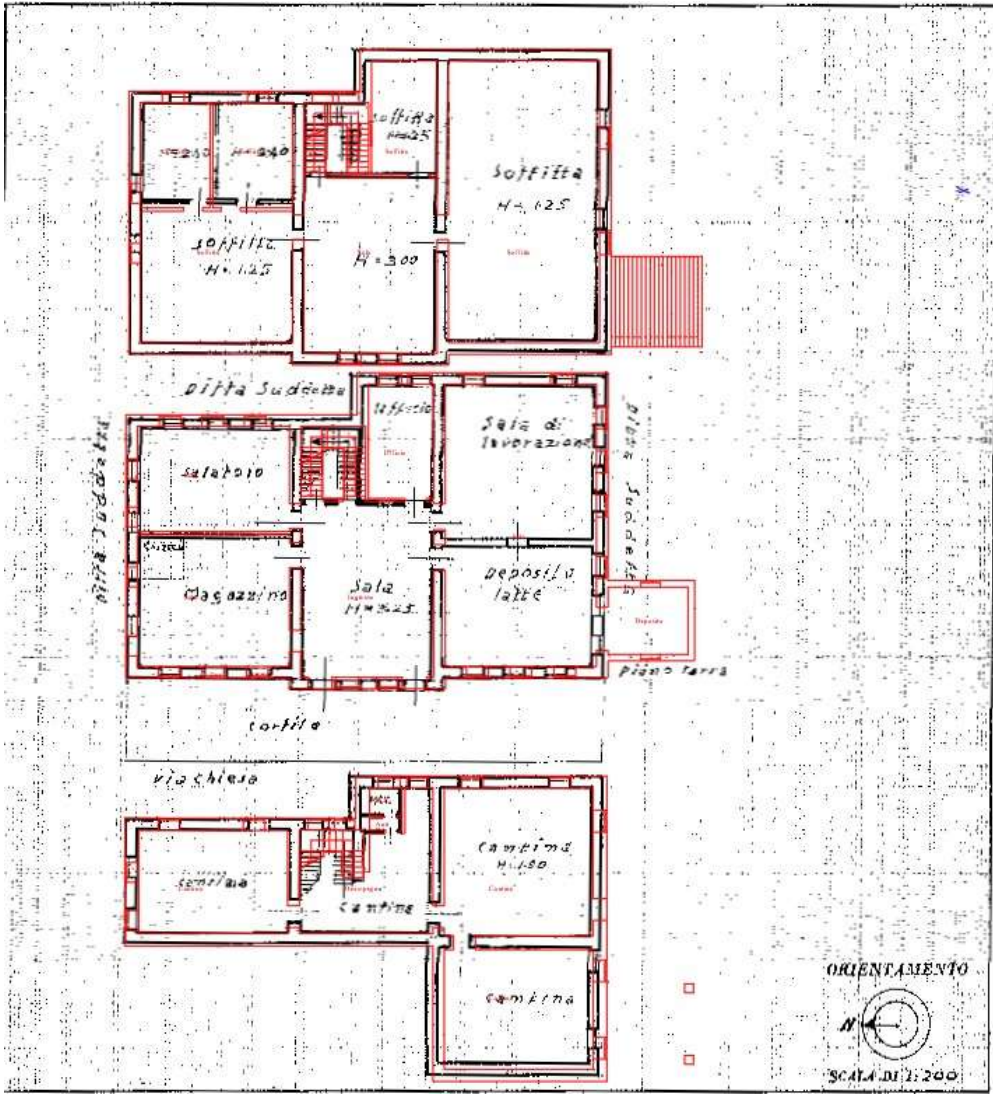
Sovrapposizione planimetria catastale con stato rilevato (fuori scala) – (Allegato N.2)
